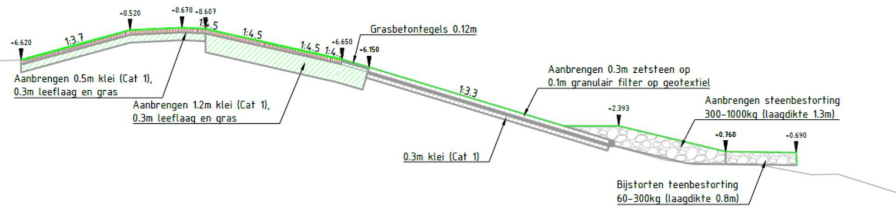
VO-ontwerp voor sectie 0, Cleveringsluizen op het grondlichaam tussen betonconstructie. Ook de aansluiting tussen de Cleveringsluizen en de Westelijke Havendam is onderdeel van sectie 0. De bekleding van deze aansluiting kent de volgende eigenschappen:
